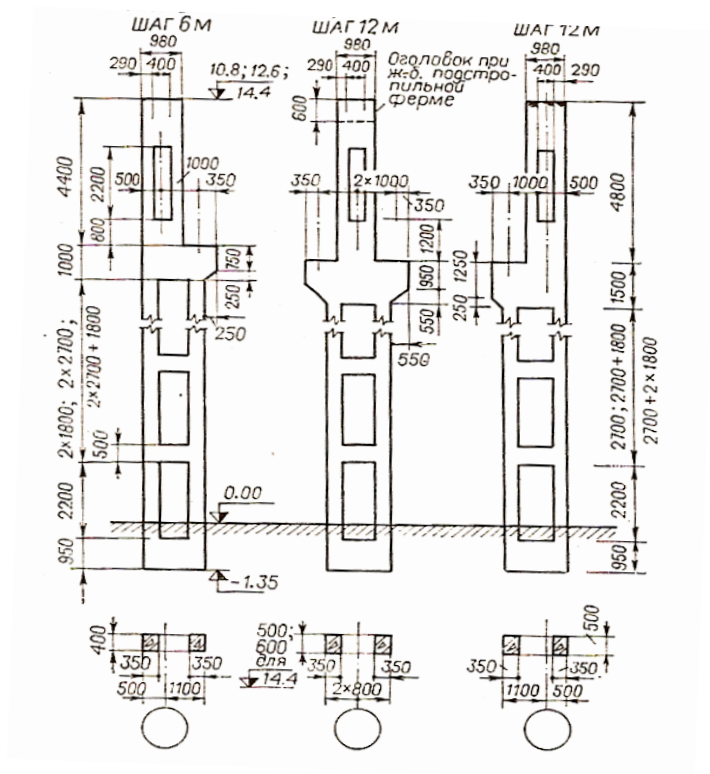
Двухветвевые железобетонные колонны с проходами в уровне крановых путей
